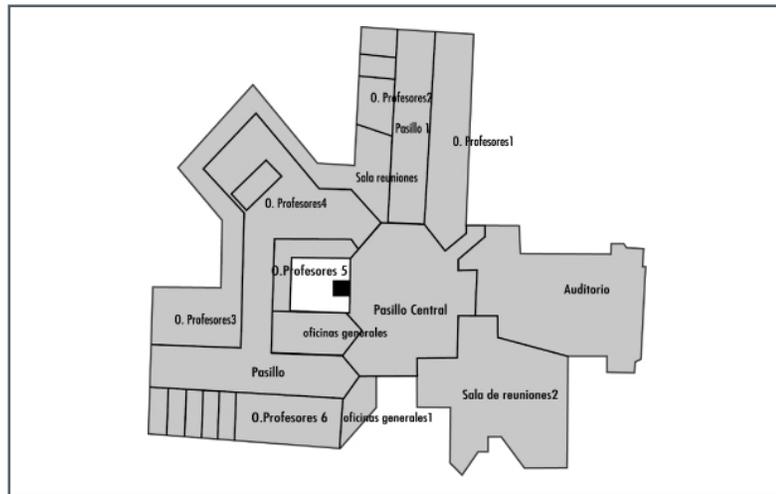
| Áreas planta baja edificio FIEC (ESPOL).
